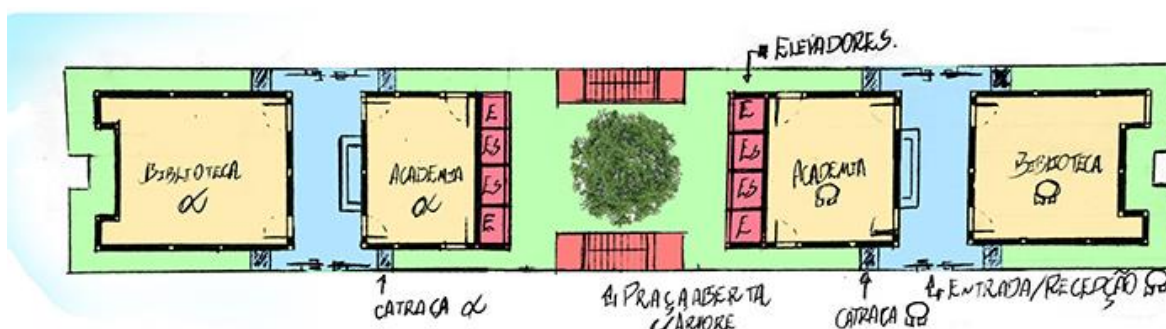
Croqui Pavimento Térreo – Projeto Sanctum.
